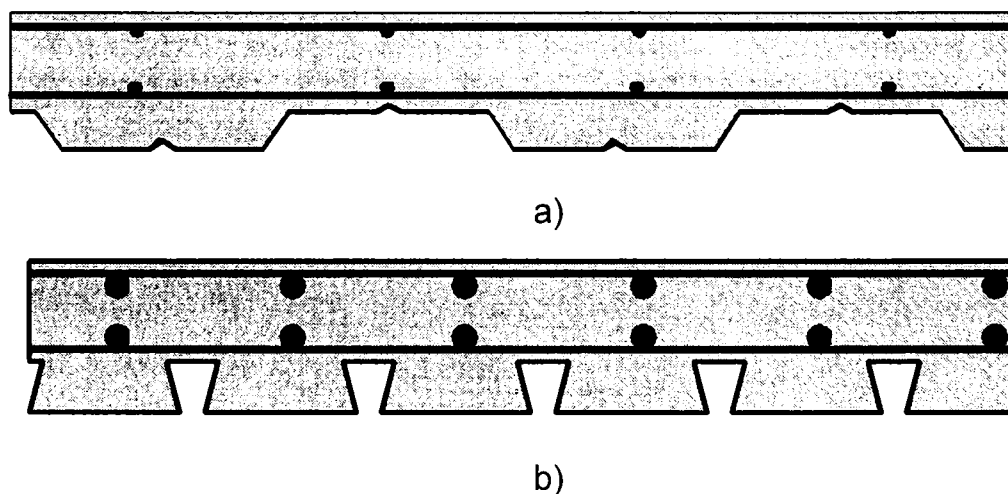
Secțiuni tipice de planșee mixte oțel–beton
